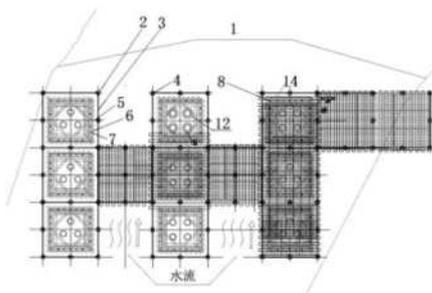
河道泄洪区域水下桩承台的施工方法的施工平面图
